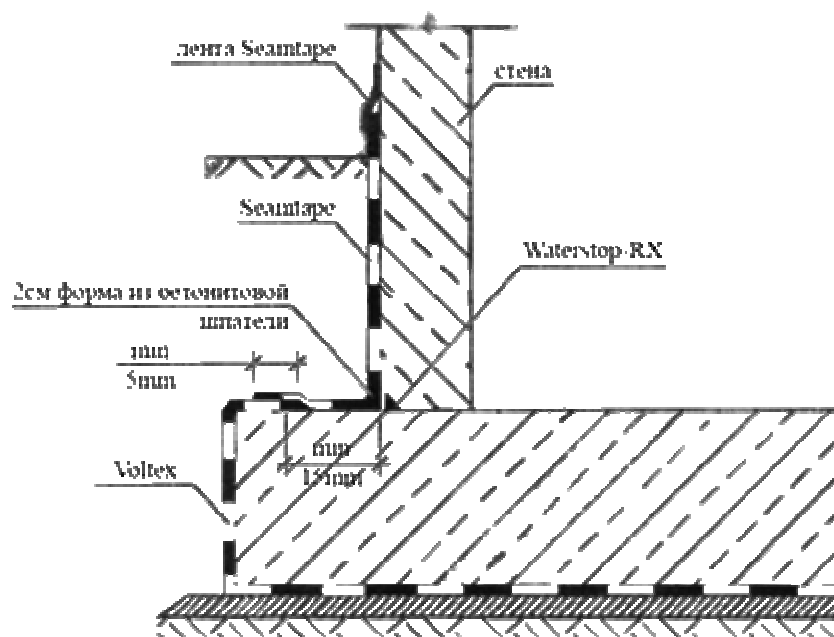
Наружная минеральная гидроизоляция бетонных плит оснований и стен подземных сооружений в условиях воздействия грунтовой влаги
